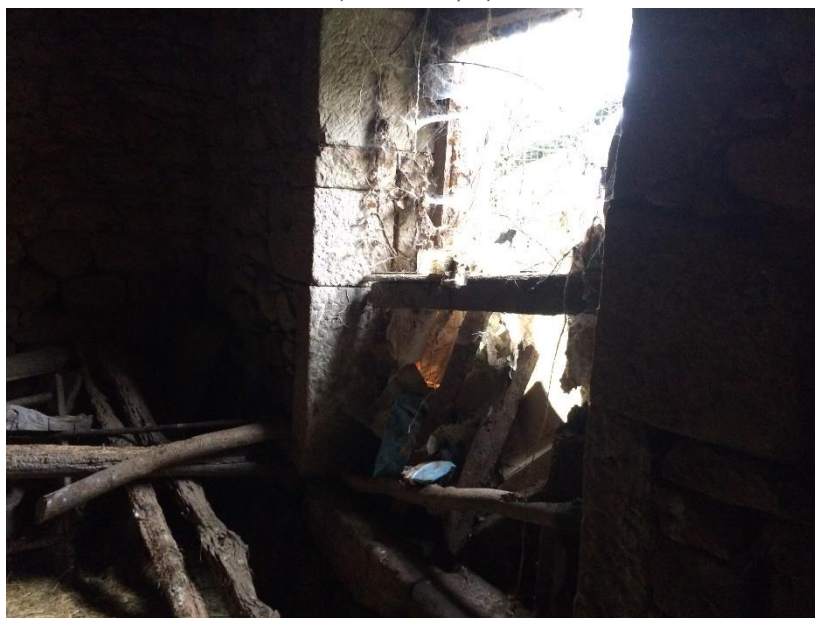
Vista interior de la zona de cuadras en la planta baja.
